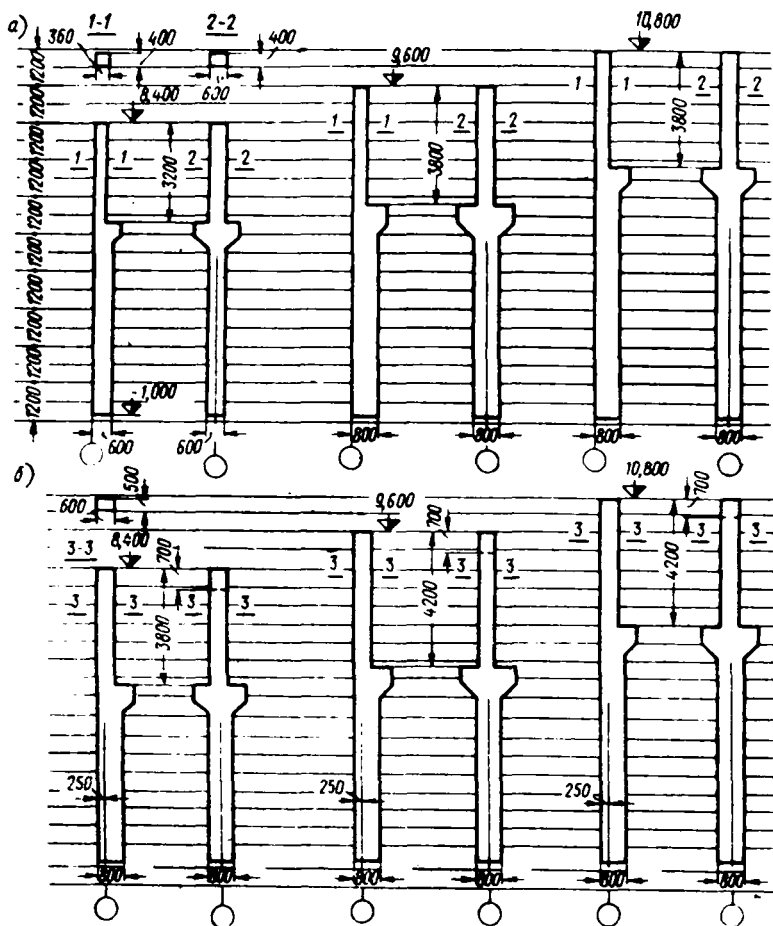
Типовые колонны прямоугольного сечения серии КЭ-01-49 для зданий с мостовыми кранами
